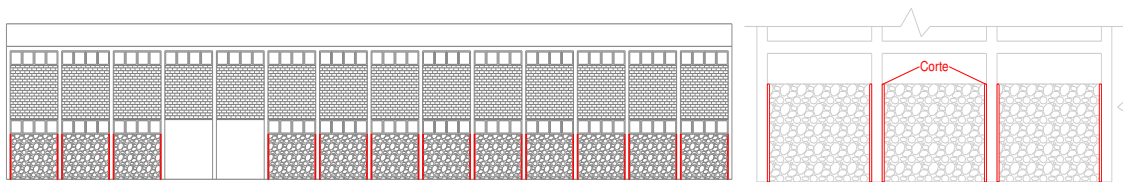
Propuesta F - Esquema de disposición (izquierda) y detalle esquemático (derecha).
